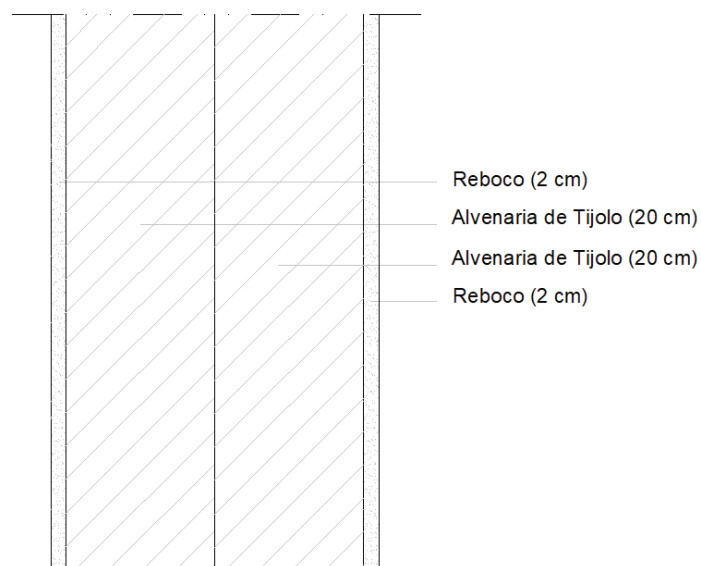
Pormenor construtivo da parede interior tipo III (escadas)
